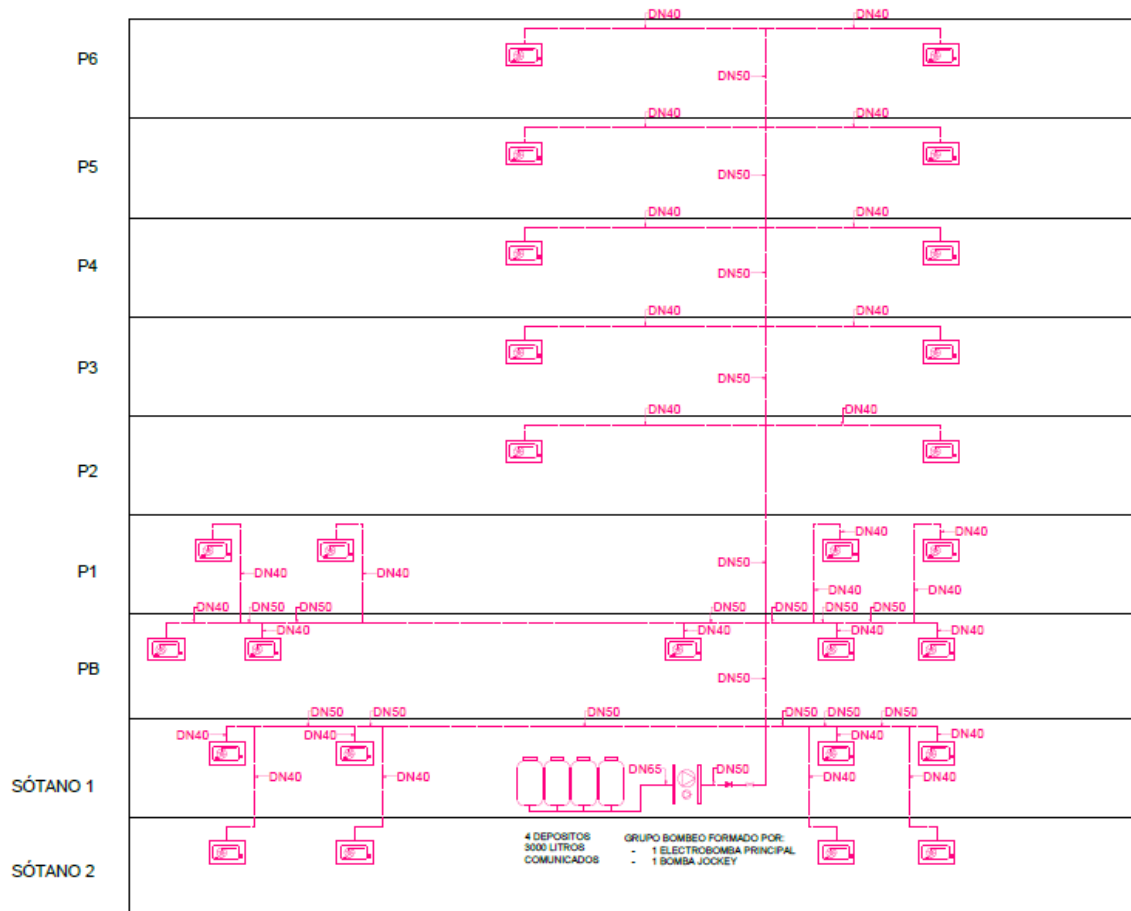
Esquema vertical red 27 BIEs por plantas. Planos del proyecto
